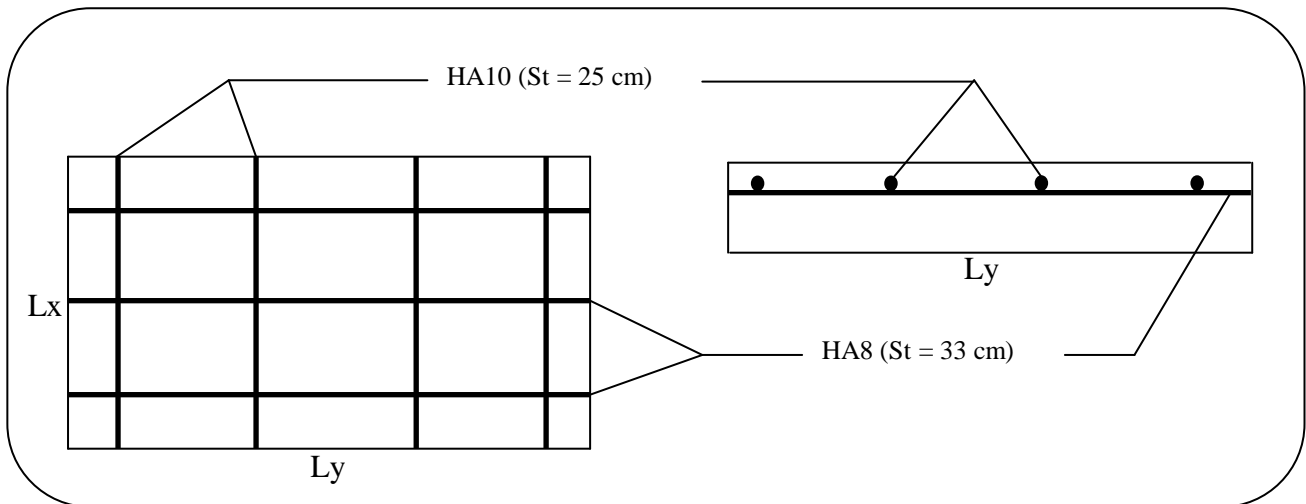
Schéma de ferrailage de la terrasse inaccessible
